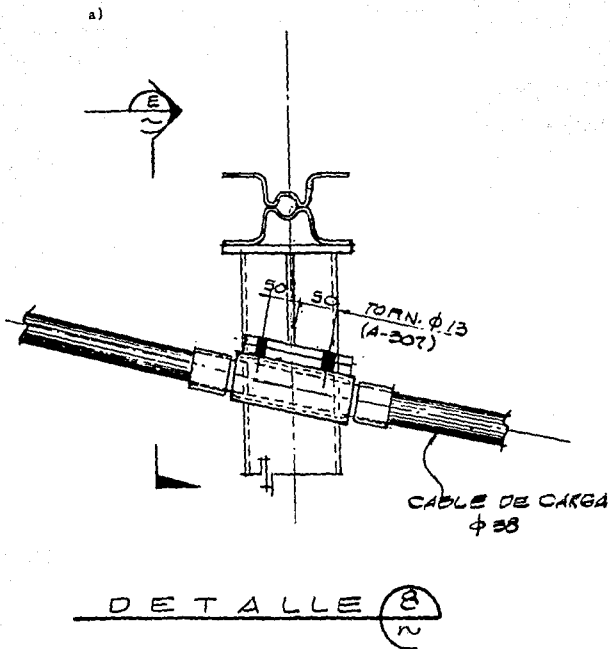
Conexión cables de carga-punta-joist en los extremos de la armadura.
